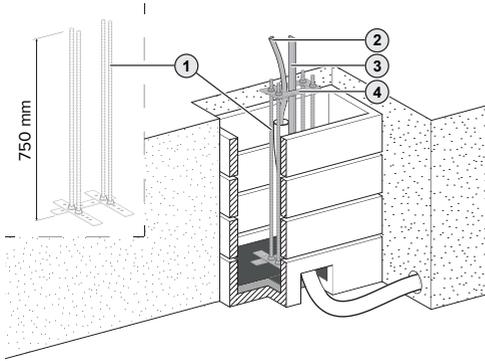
Installation du kit de fixation sur fondations, y compris dalle de fondation (exemple : AMEDIO®)
